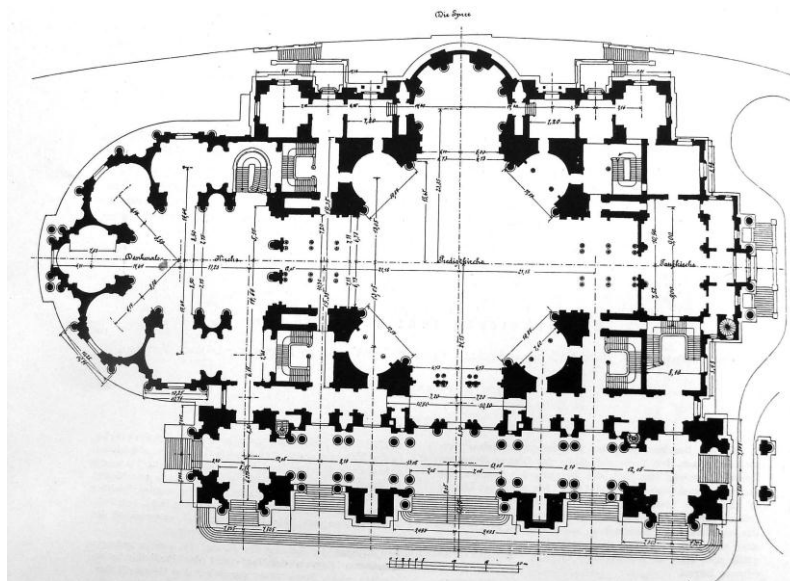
Dom zu Berlin. Grundriss 1: 500
